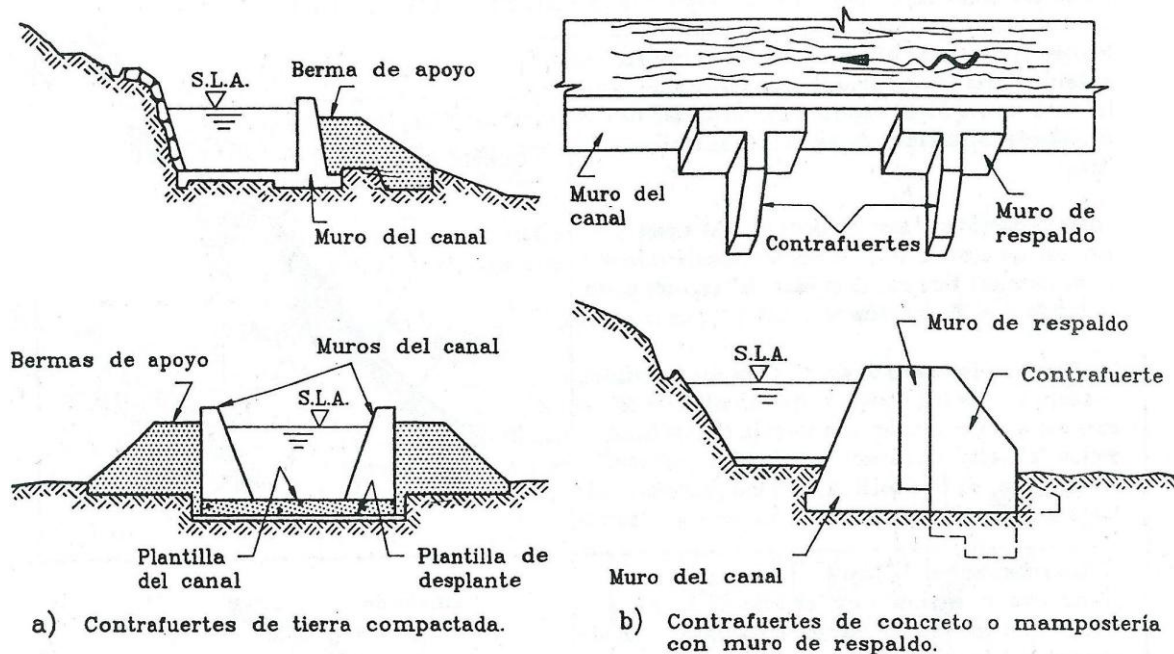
Estructuras para apoyo de muros de canales, contra el volteo (CFE, 1991)
